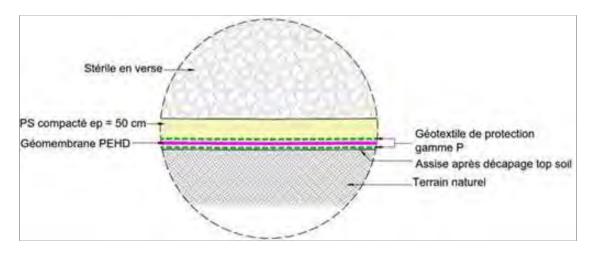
Dispositif d'étanchéité de la verse Ouest
